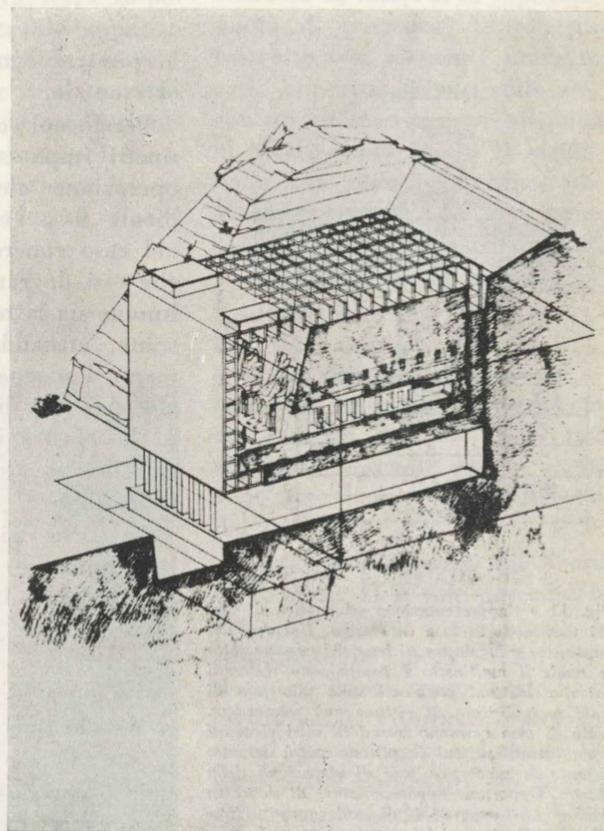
Vista assonometrica del blocco ormai completamente racchiuso nel cassone in cemento armato (in fase di sollevamento).
